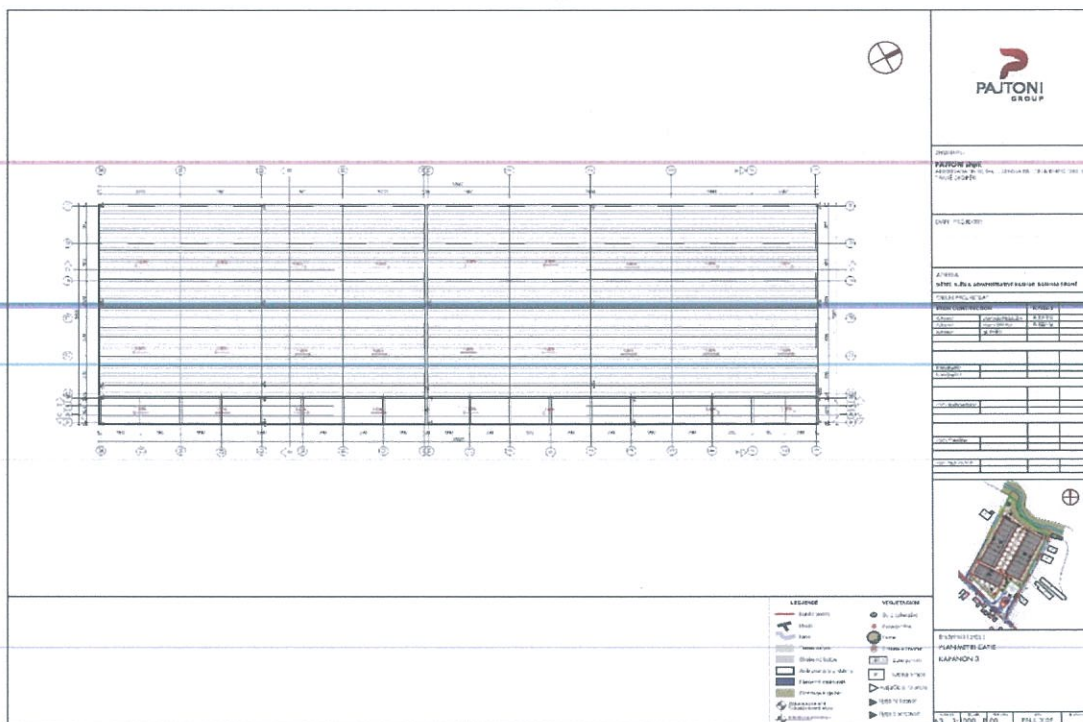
Planimetria e çatisë së Kapanonit 3.
